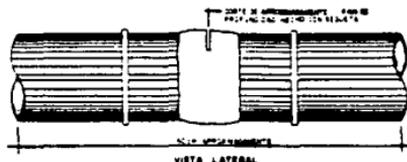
b) Probeta para prueba de sanidad en soldaduras de varilla.
